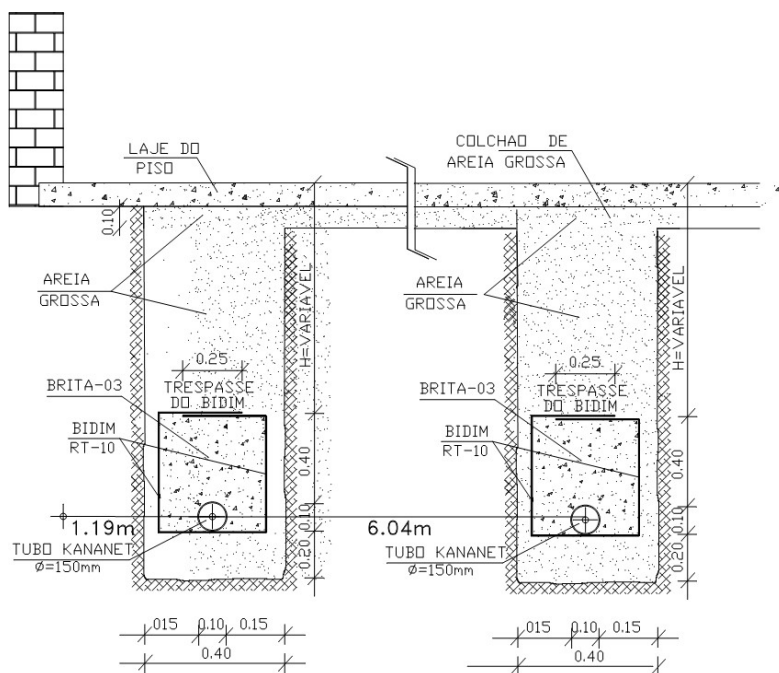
Detalhe construtivo dos drenos do sistema de drenagem subterrânea. Fonte: Autor do Trabalho.
